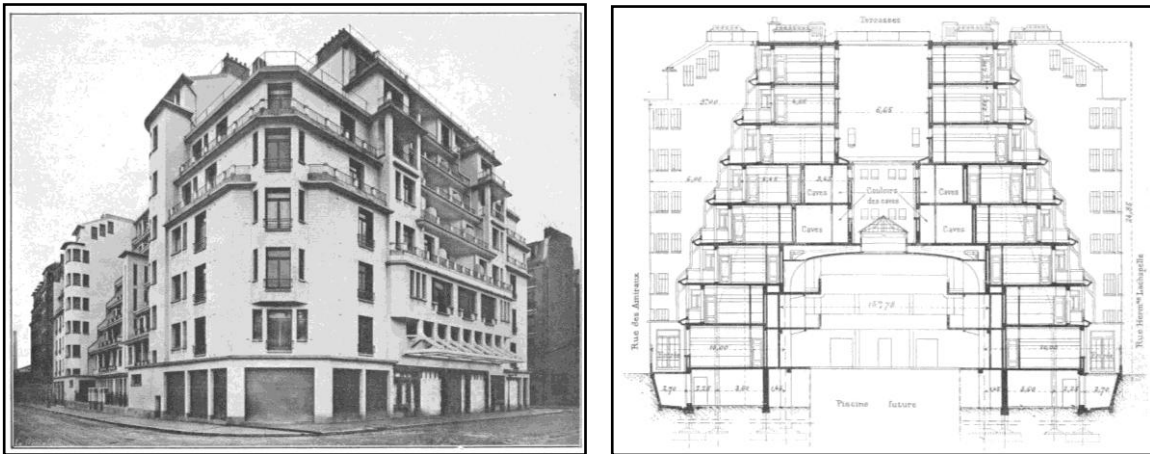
Façade et coupe transversale d'un immeuble à loyer à bon marché, de la Ville de Paris
